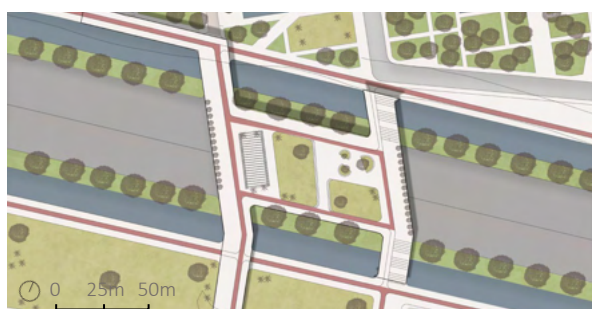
Acesso às plataformas em rampa e em escada, planta
